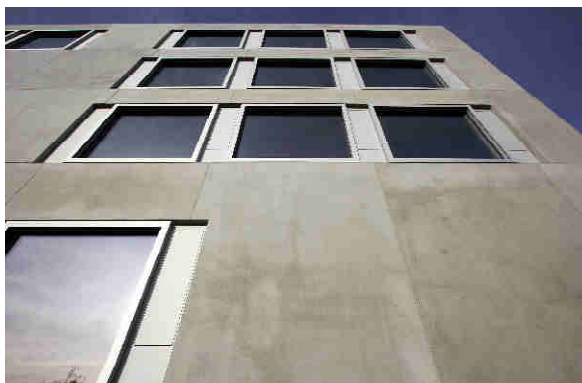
Neubau Hochschulgebäude mit tragender Sandwichfassade aus Stahlbeton
